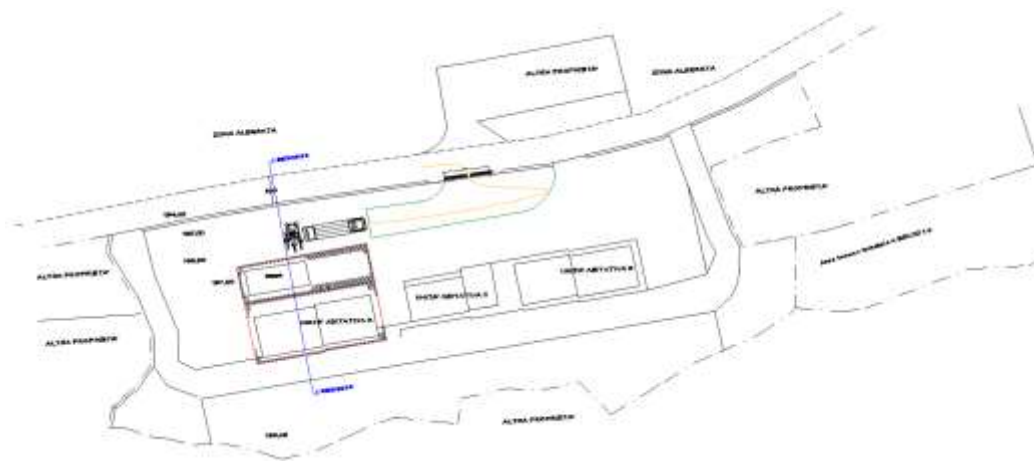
Stralcio del layout di cantiere con indicazione degli scavi
